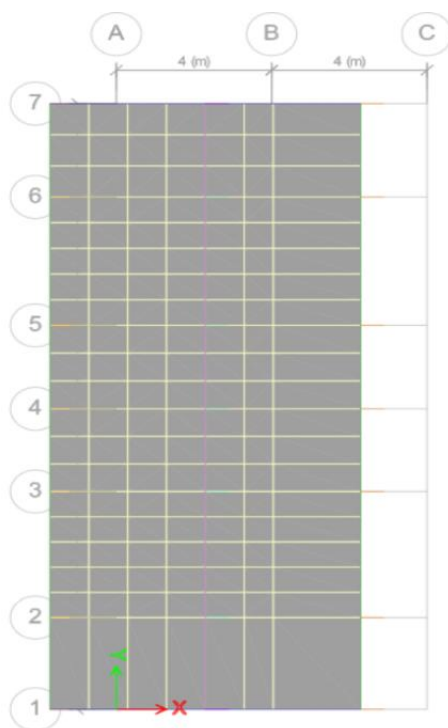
Deformación por fuerza de sismo vista en planta Etabs
